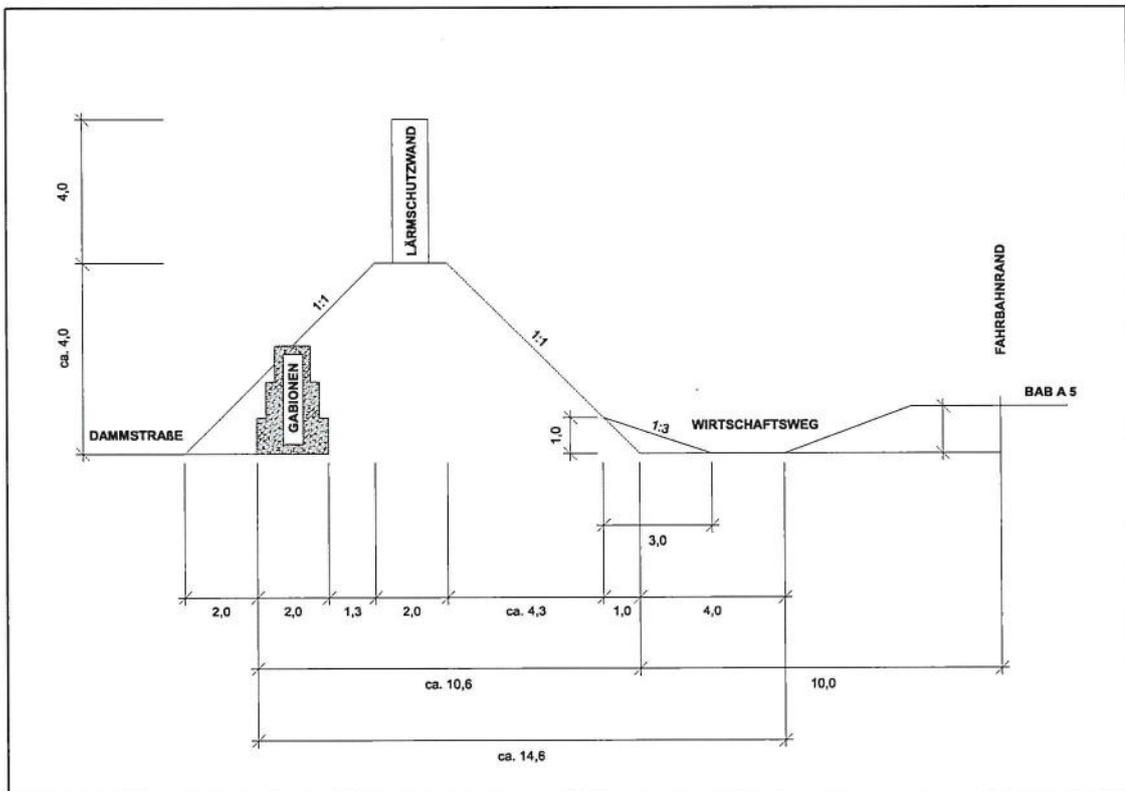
Lärmschutzwallausbildung entlang der Bundesautobahn A 5
